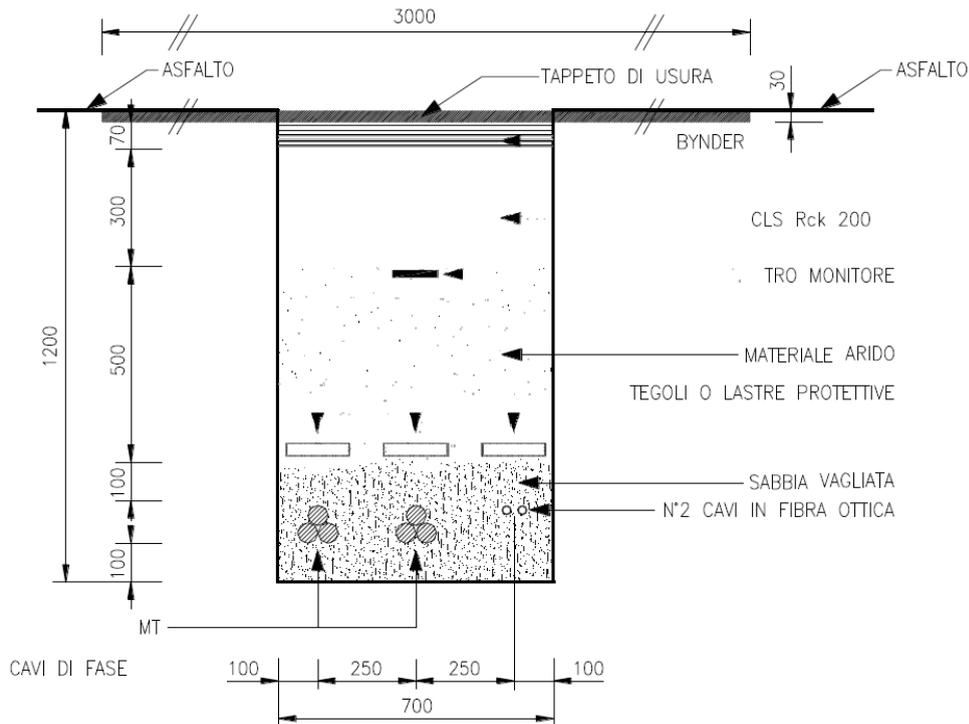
Sezione tipica di posa della linea in cavo su sede stradale
